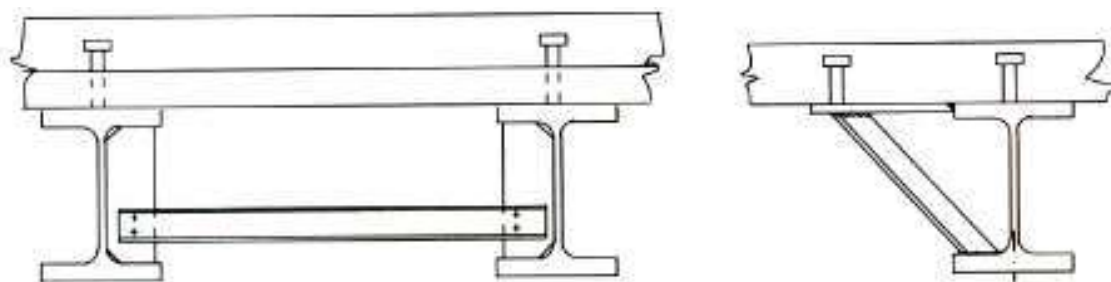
Примеры связей сталежелезобетонных балок в уровне нижнего сжатого пояса
